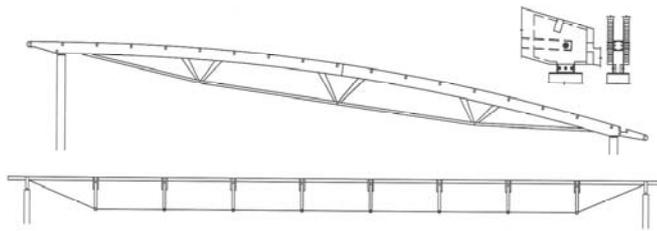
Arco de madera con tirante inferior, detalle de unión tirante-arco y estabilización de los tirantes fuera de su plano.
